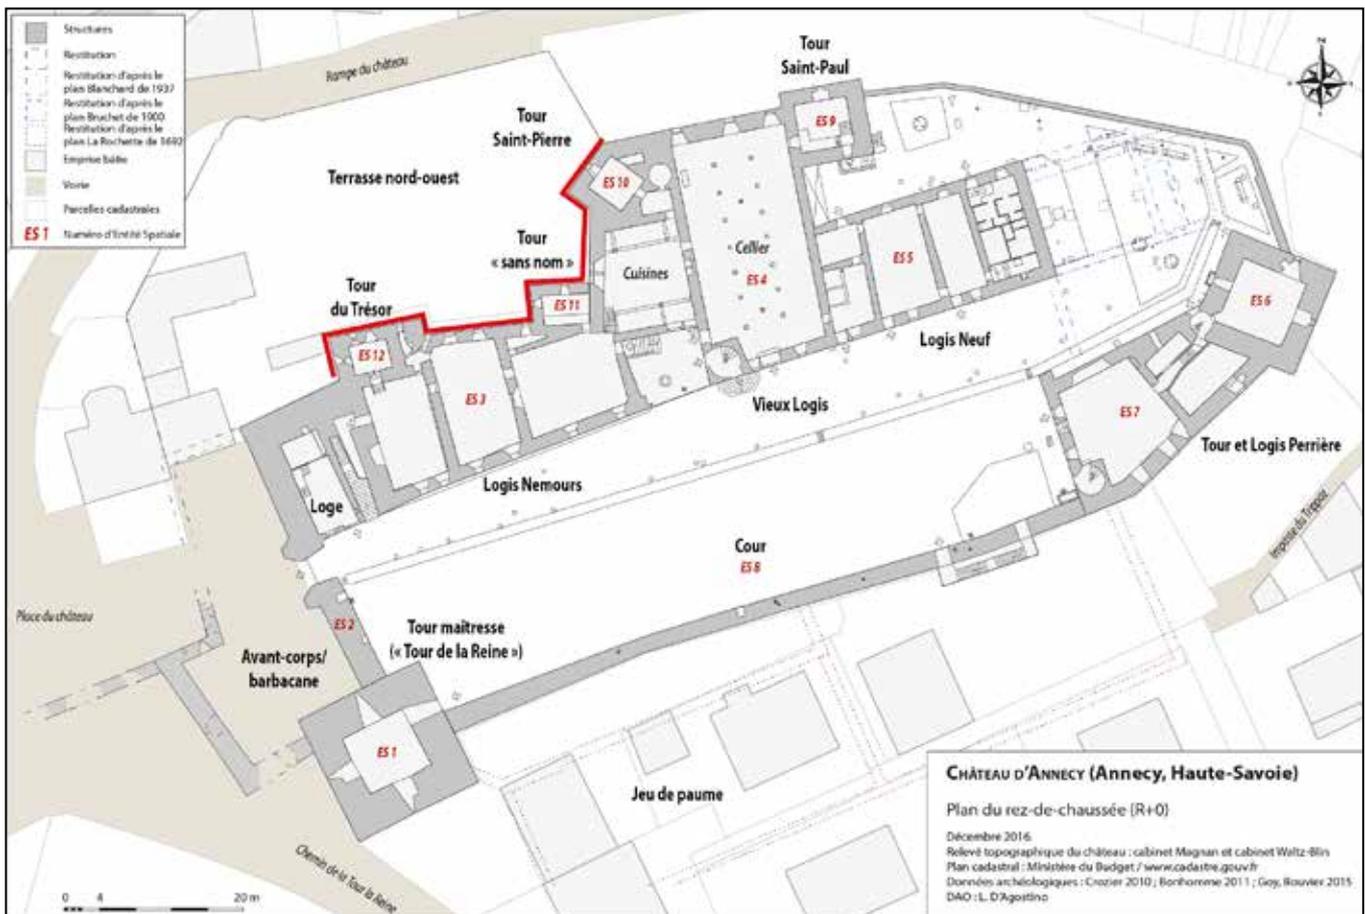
Château d'Annecy, plan au rez-de-chaussée et zone d'étude. DAO : L. D'Agostino.
